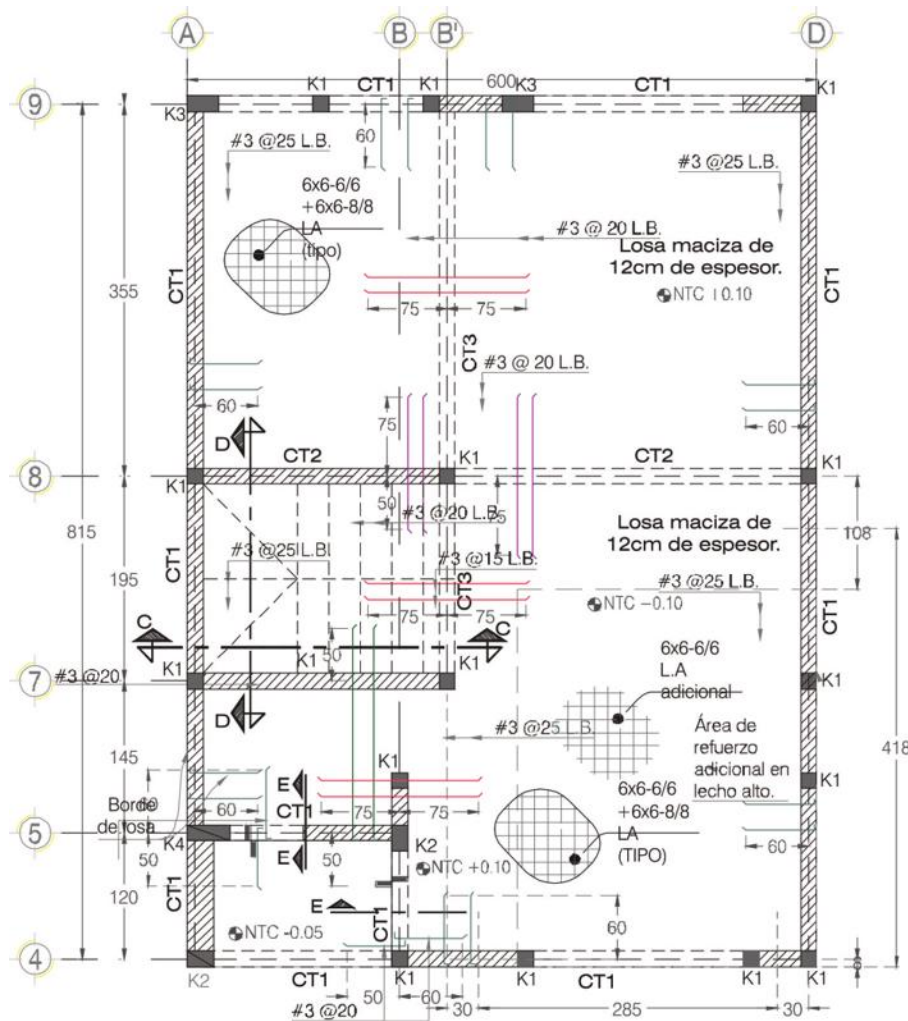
PLANTA DE CIMENTACIÓN ROBLE QUE MUESTRA LOS BASTONES DEL ARMADO.
